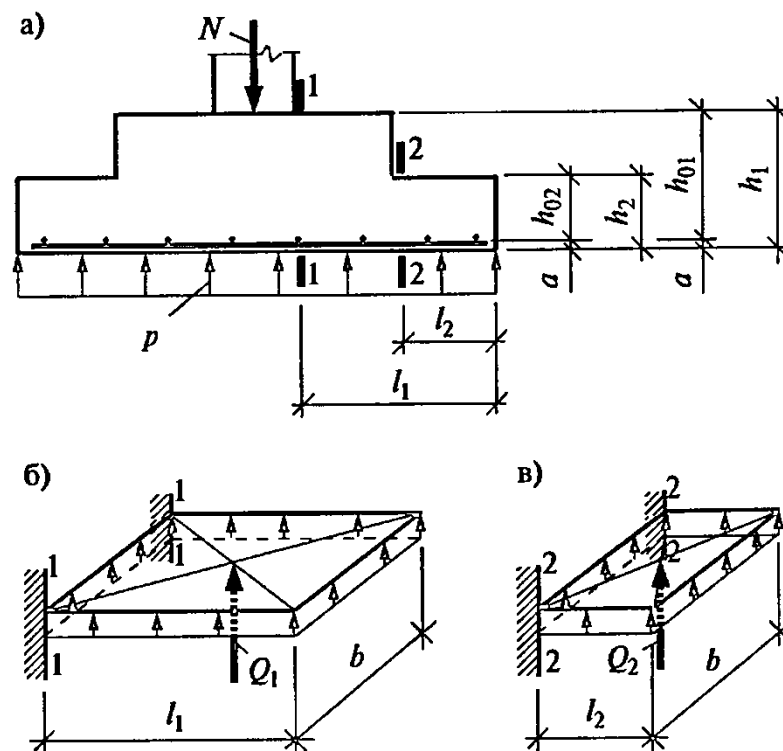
К расчету арматуры фундамента: а) расчетные сечения фундамента; б) часть подошвы фундамента, отсеченная сечением 1-1; в) то же сечением 2-2
